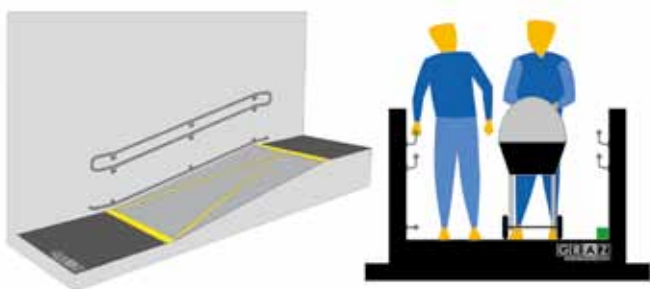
Rampe mit beidseitigen Handläufen und Radabweisern
